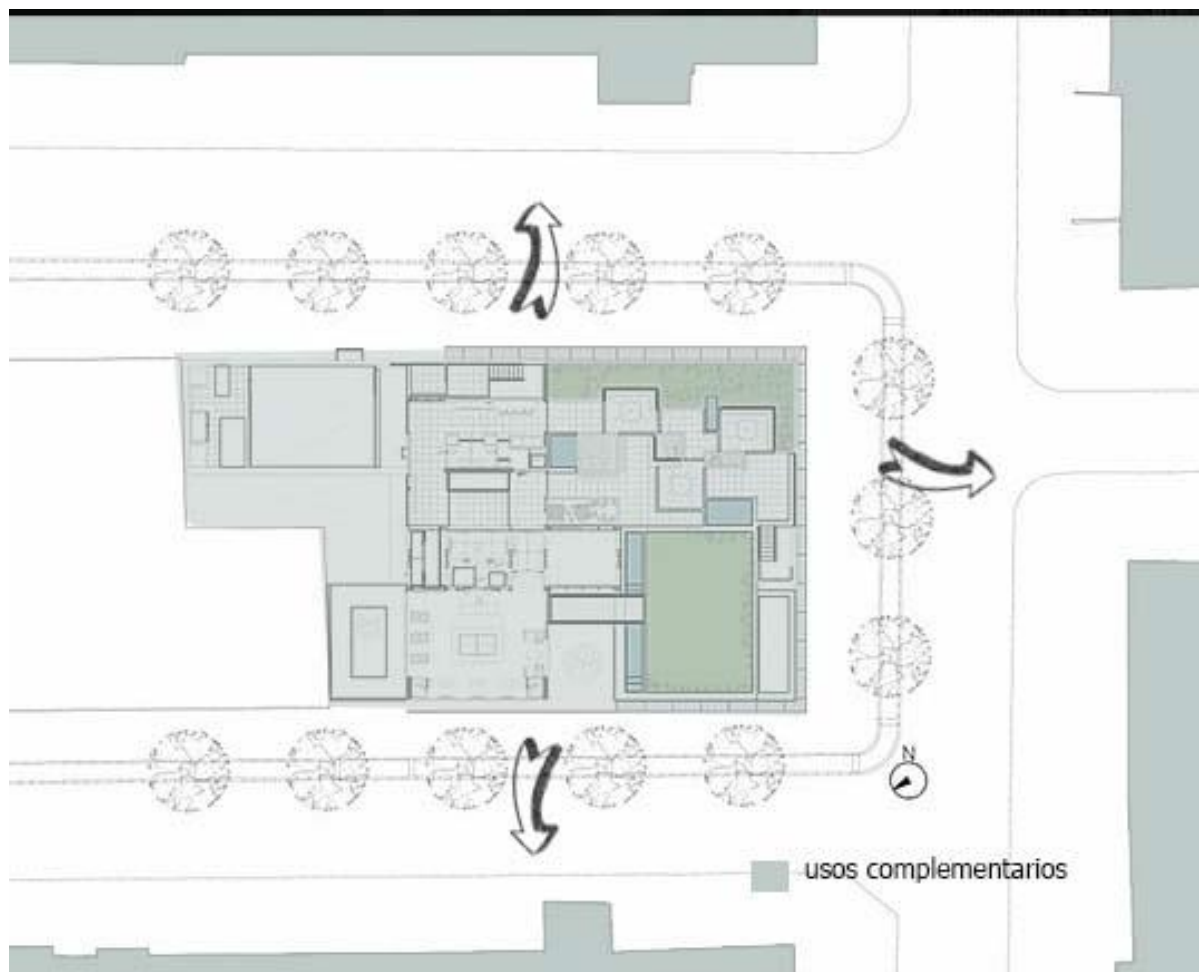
Planta emplazamiento, (Archdaily, 2015)
